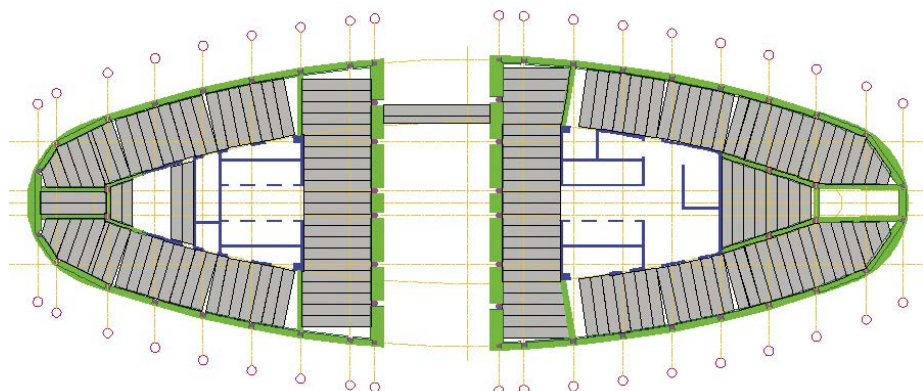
Aus rechteckigen Deckenplatten lassen sich auch unregelmäßige Grundrisse realisieren.
